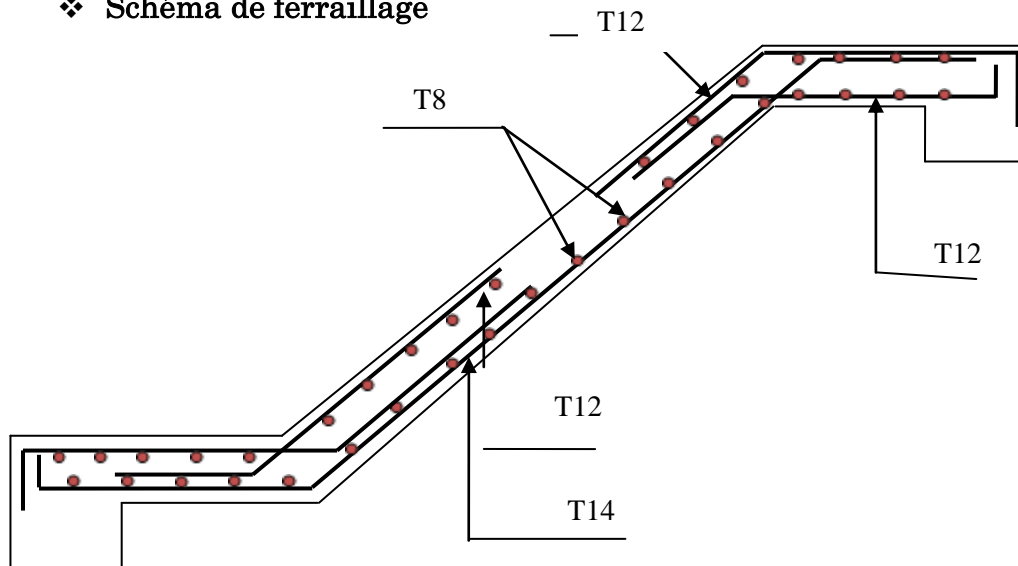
Schémas du ferrailage de la volée I de l'escalier type II(RDC)
